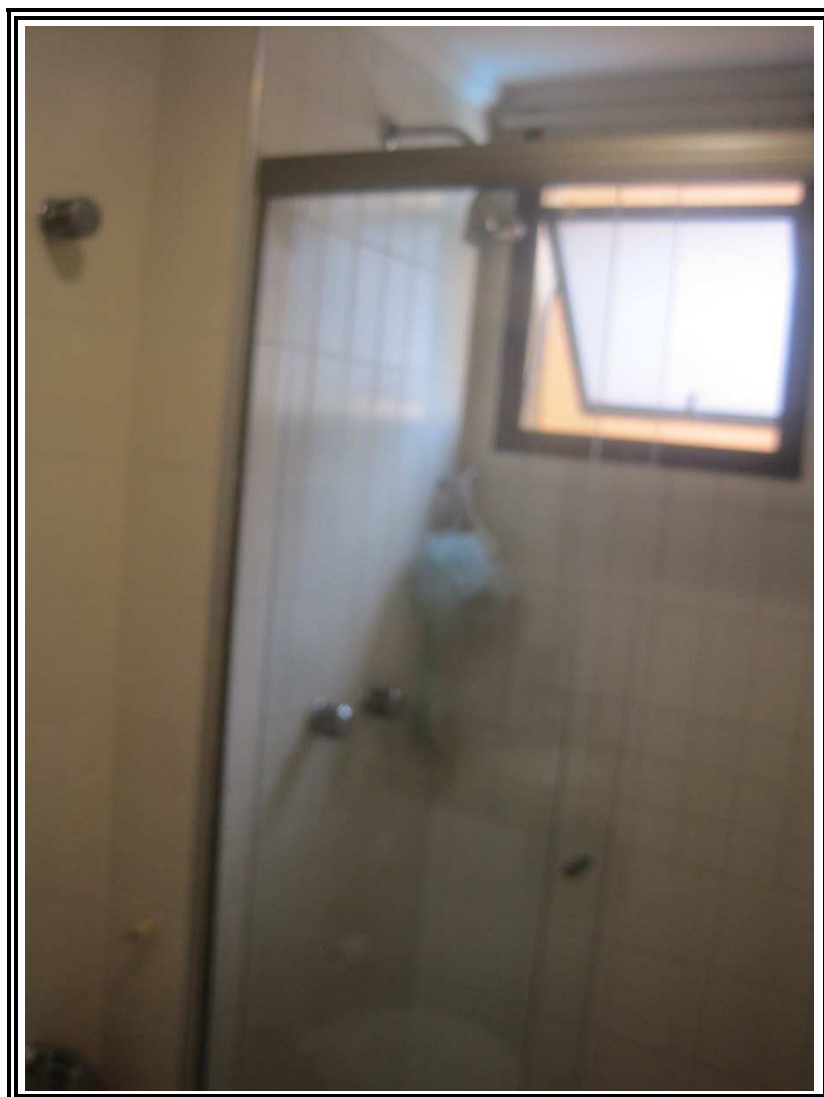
Vista do banheiro do dormitório 02 (suíte)
